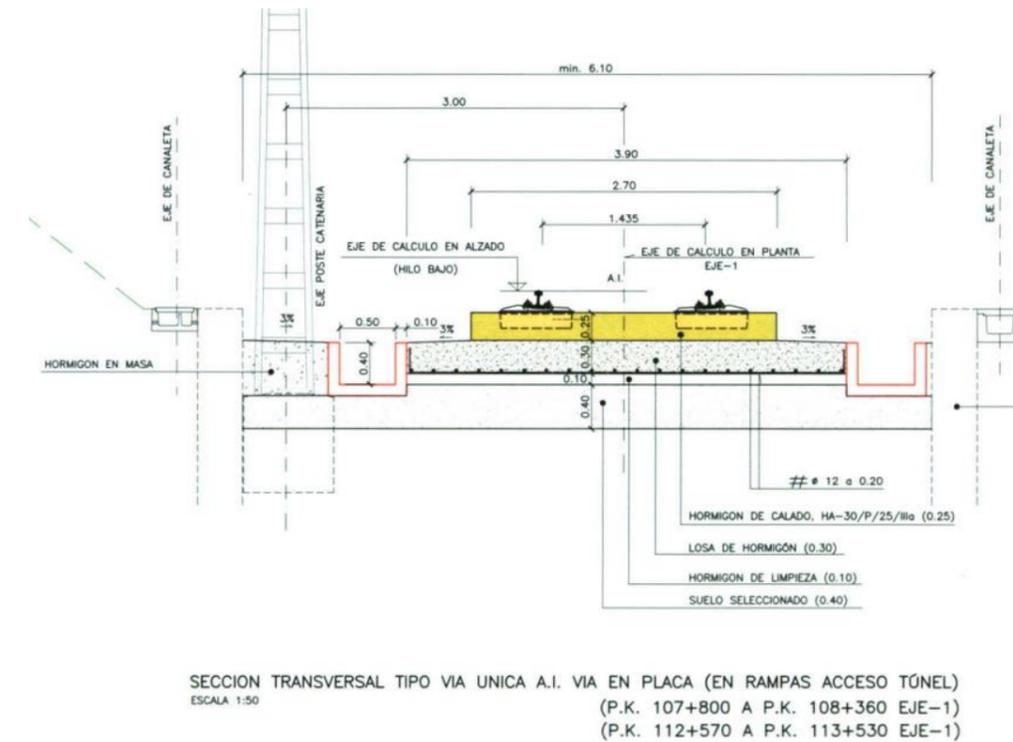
SECCIÓN TIPO DEL PROYECTO TORRELLANO – CREVILLENTE (RAMPA DE ACCESO A TÚNEL)
